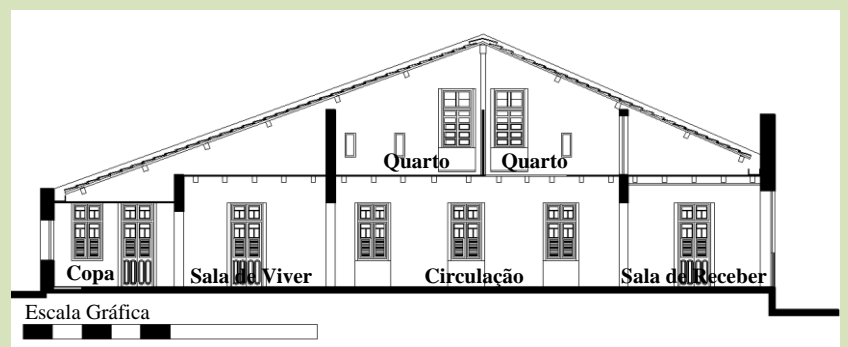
Corte B B' da Casa 5. Fonte idem.
